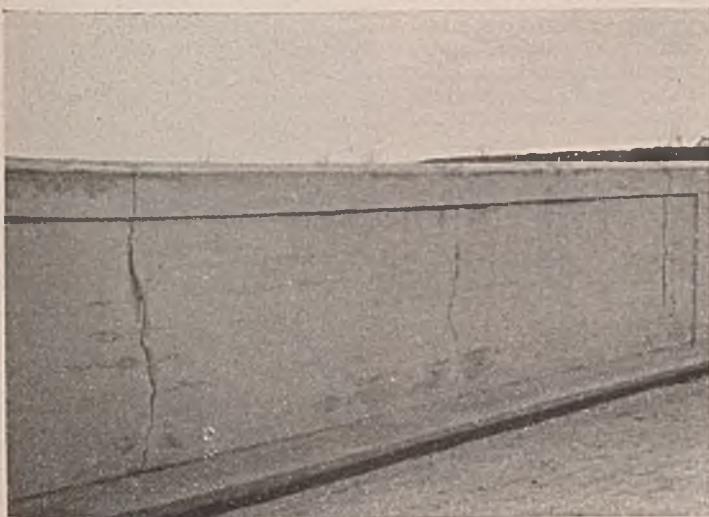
Spaltrisse in einer Eisenbetonbrüstung.
